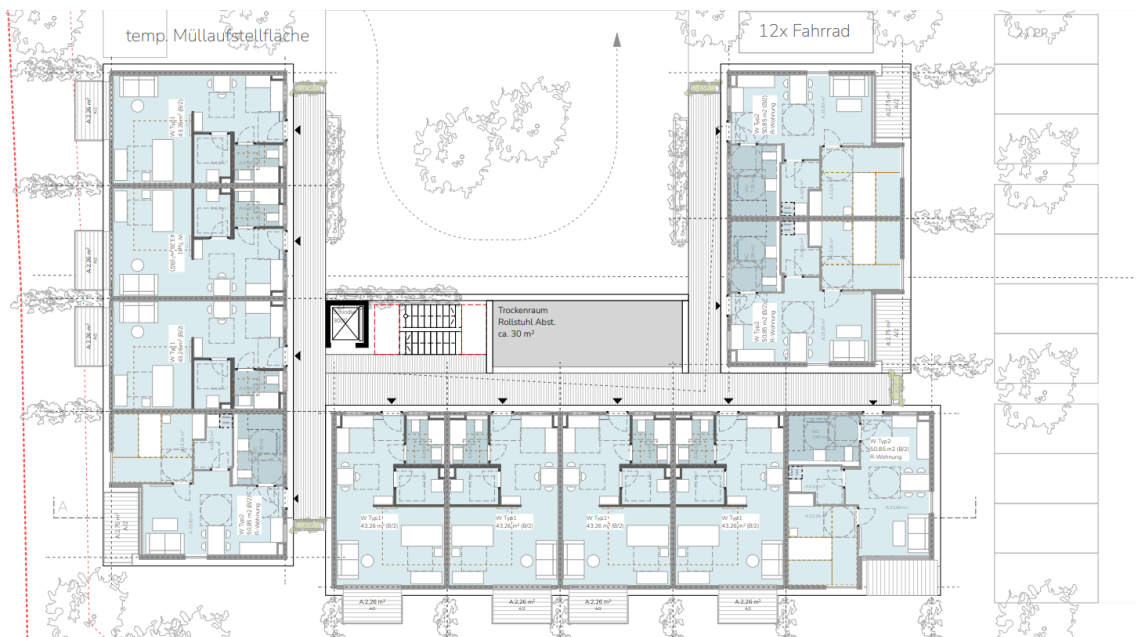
Gebäudekomplex Grundriss 1.OG, ohne Maßstab, Quelle: AP+M Architekten GmbH, Stand vom 26.08.2025
